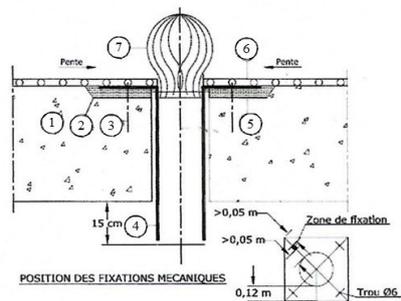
Exemple de traitement d'une évacuation d'eau pluviale avec platine
